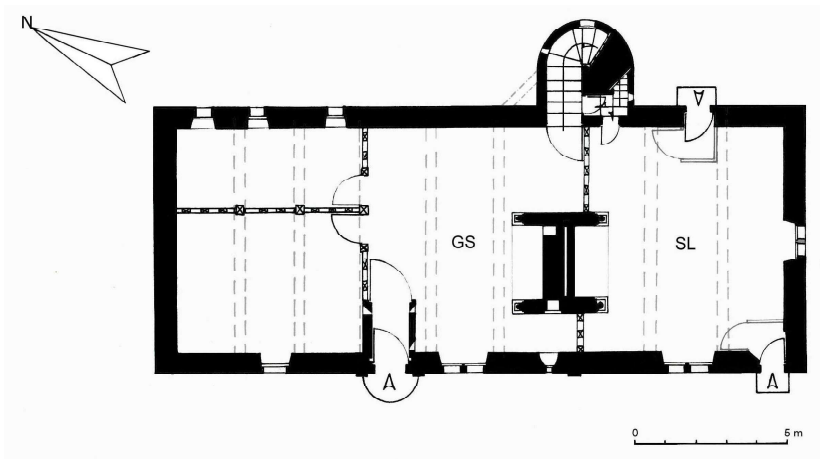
Mentheville. Plan restitué du rez-de-chaussée entre 1595 et 1606.
